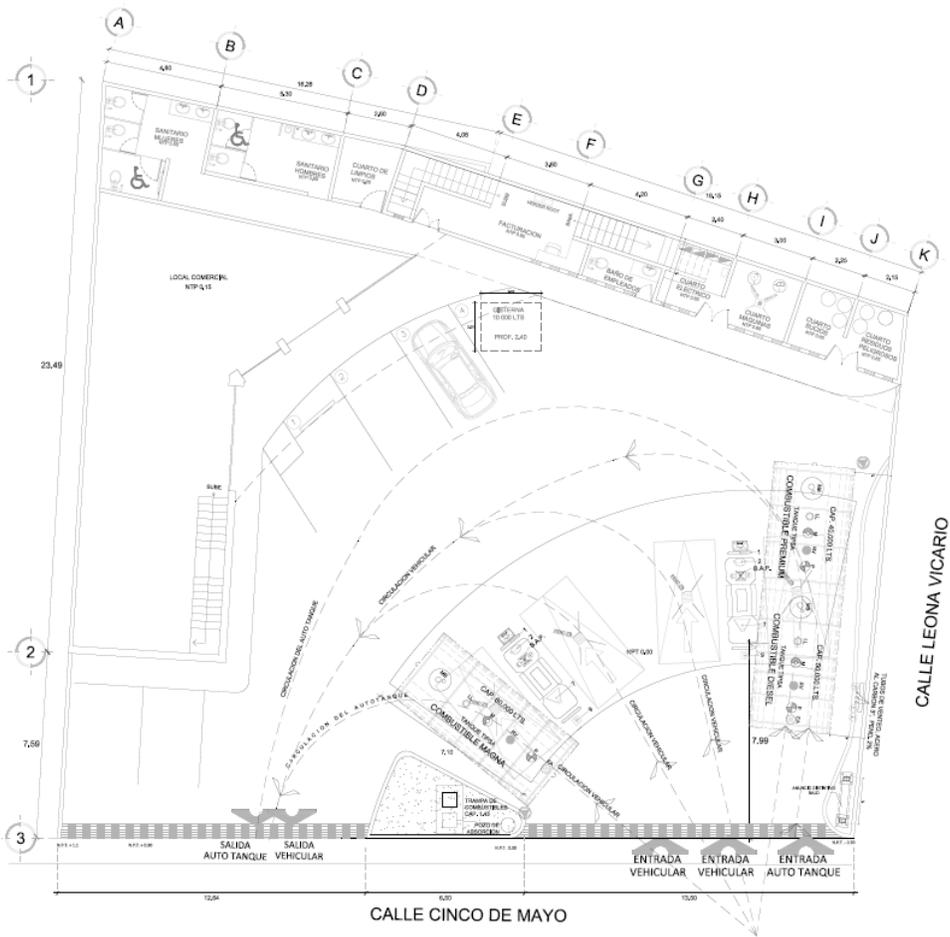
Plano de conjunto de las obras permanentes del proyecto
